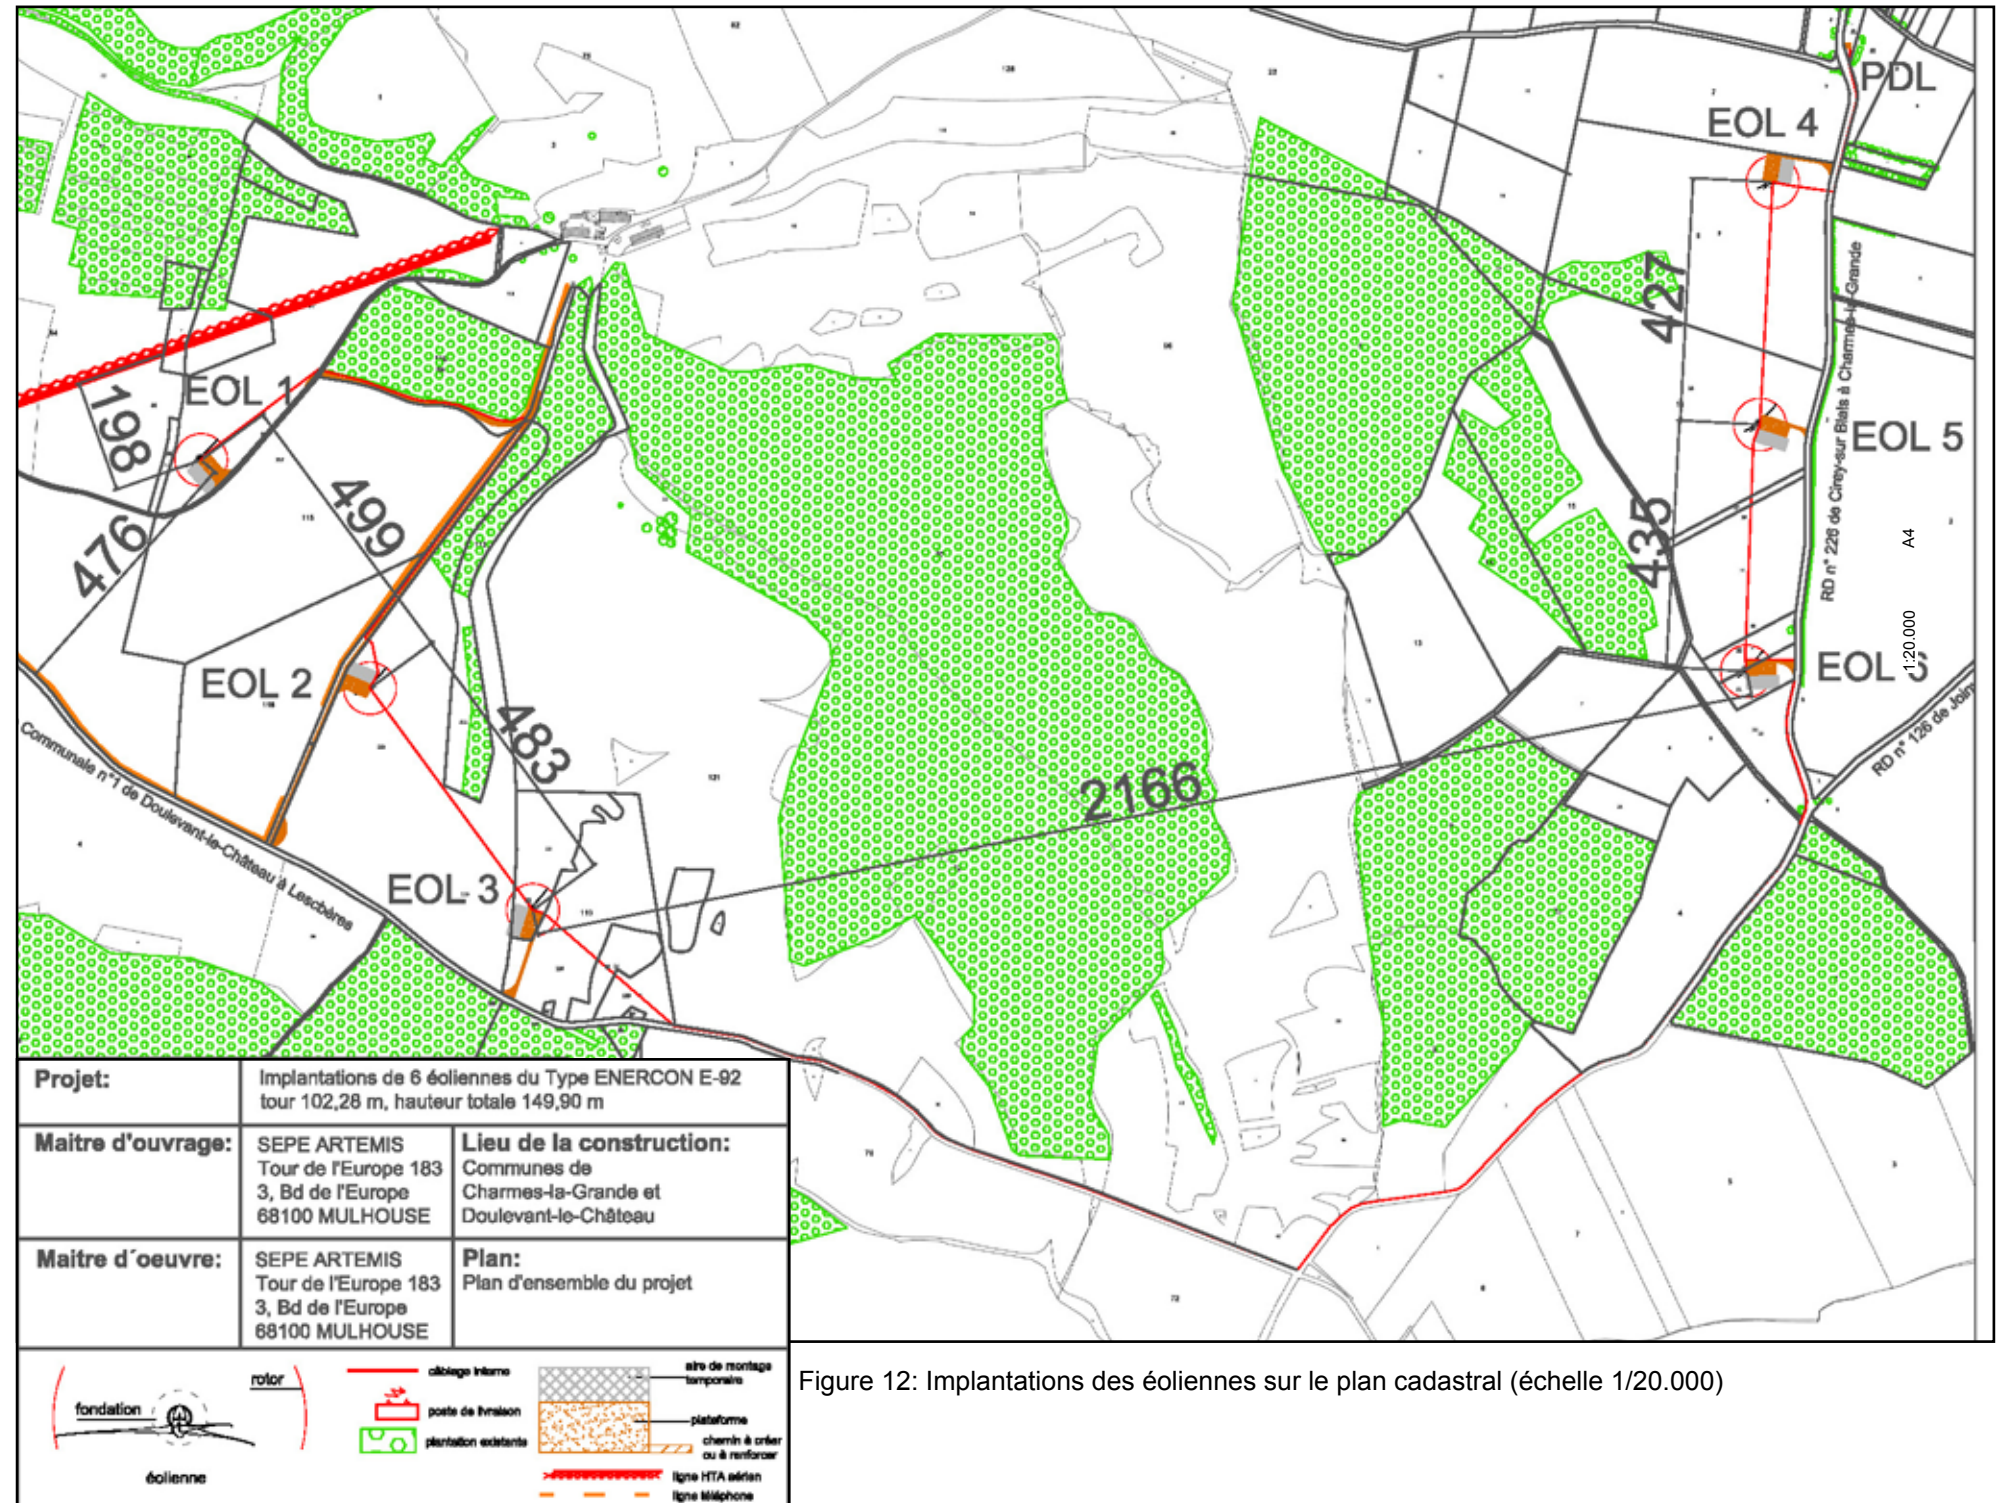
Implantations des éoliennes sur le plan cadastral (échelle 1/20.000)
